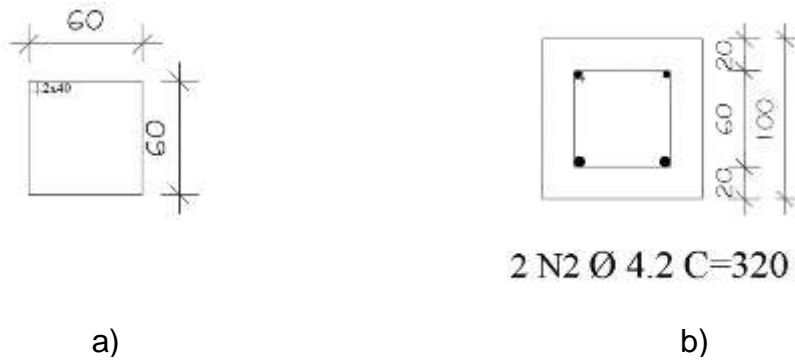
Estribo com as medidas utilizados nas vigas, (França, et al. 2018), com modificações da autora.
